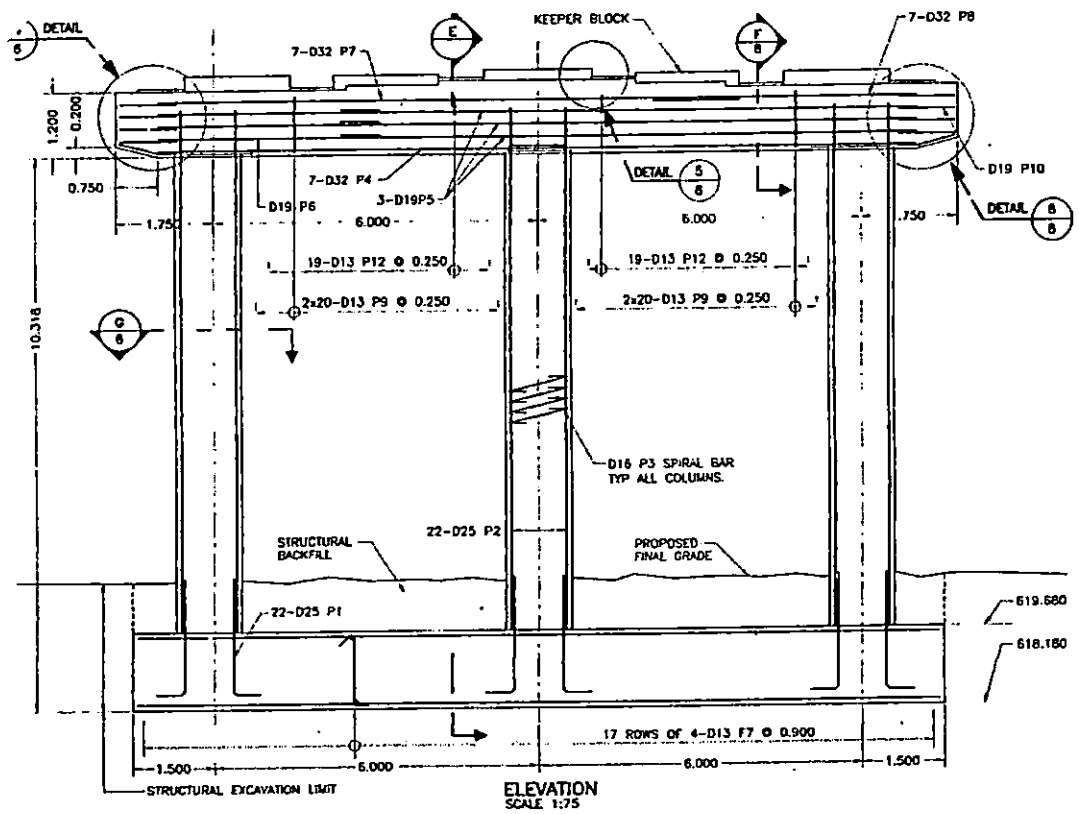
ELEVACION DE PILA CENTRAL.
